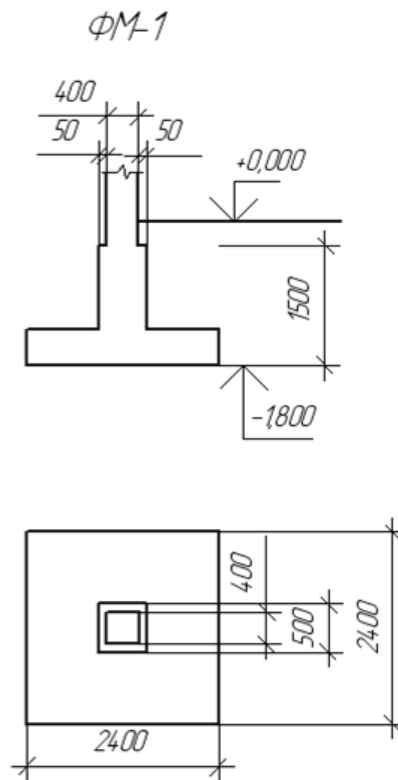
Конструювання фундаменту ФМ-1
